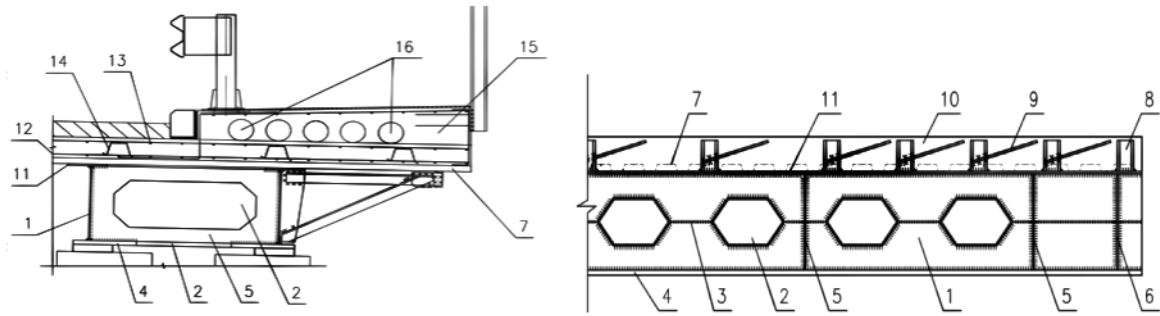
Конструкция блока пролетного строения моста: 1 — главные балки; 2 — шестиугольные отверстия; 3 — сварной шов; 4 — нижний пояс; 5 — промежуточные диафрагмы; 6 — опорные диафрагмы; 7 — профилированный лист; 8 — жесткий элемент связи сдвига; 9 — гибкий элемент связи сдвига; 10 — железобетонная плита проезжей части; 11 — верхний пояс; 12, 13 — нижняя и верхняя арматурные сетки плиты проезжей части; 14 — хомуты; 15 — тротуарный блок; 16 — неизвлекаемые вкладыши пустообразователи
